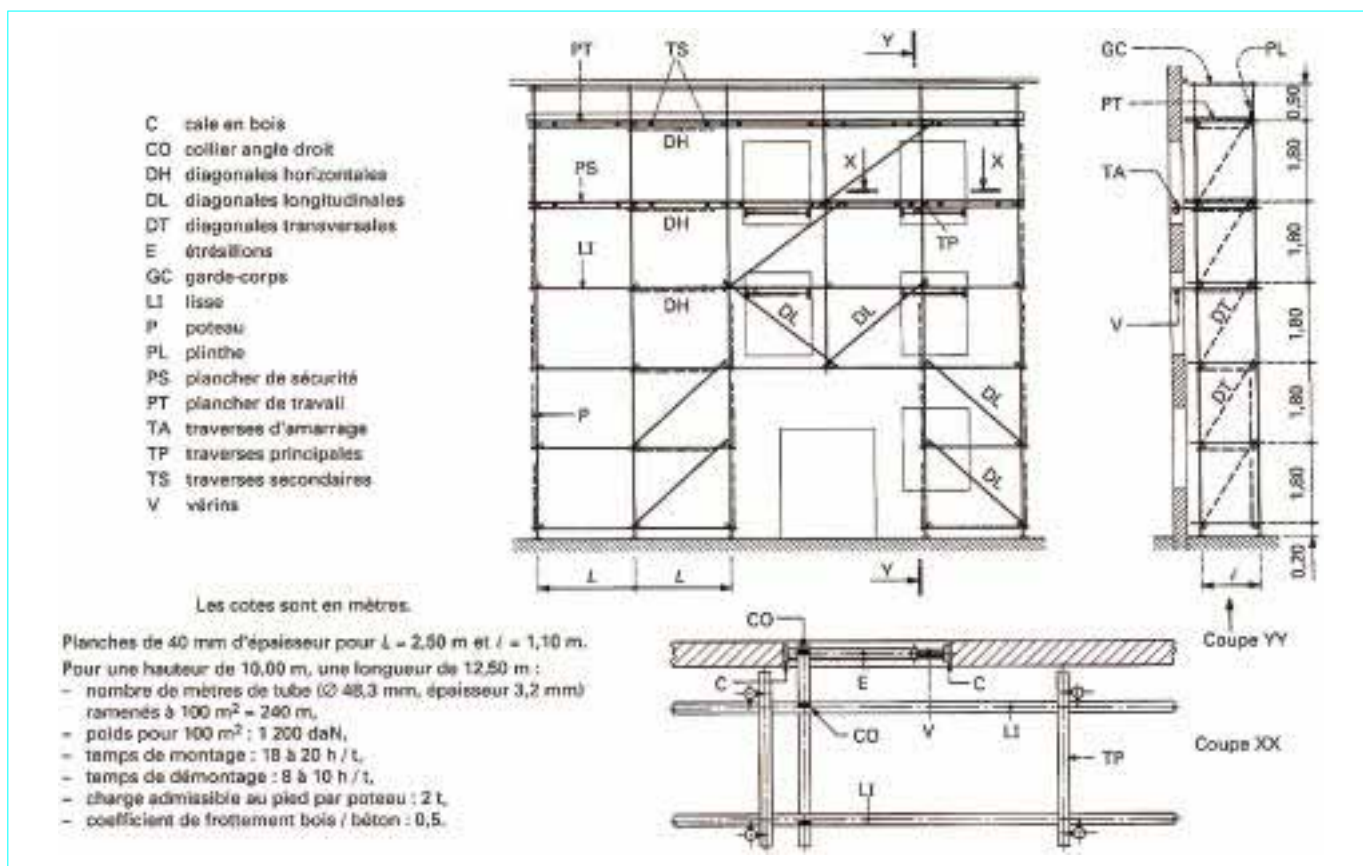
Échafaudage de façade en appui au sol, non recouvert. Exécution des planchers de travail
